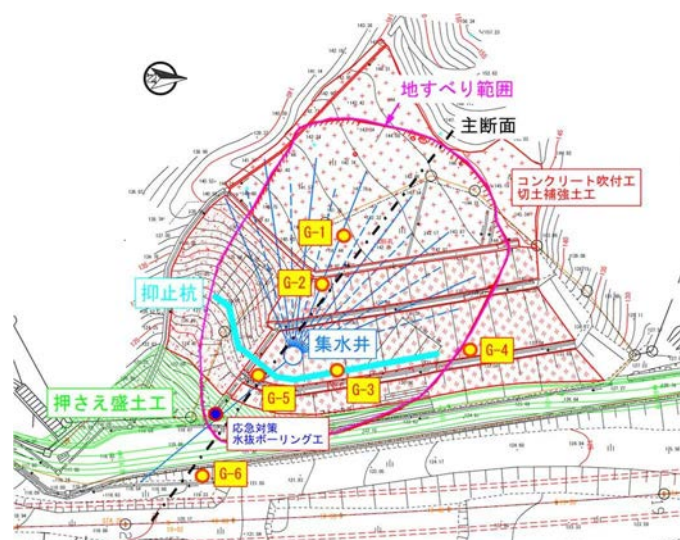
対策工平面図（抑止杭配置と GNSS 配置）
